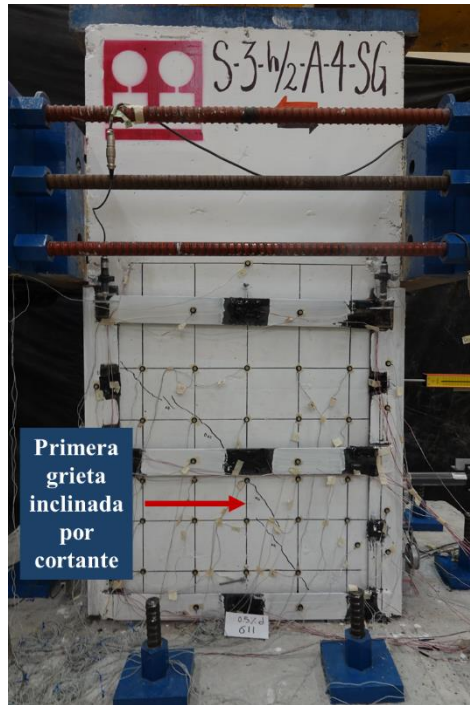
Aparición de la primera grieta inclinada en la cara Norte (ciclo 1, distorsión +0.5%).
